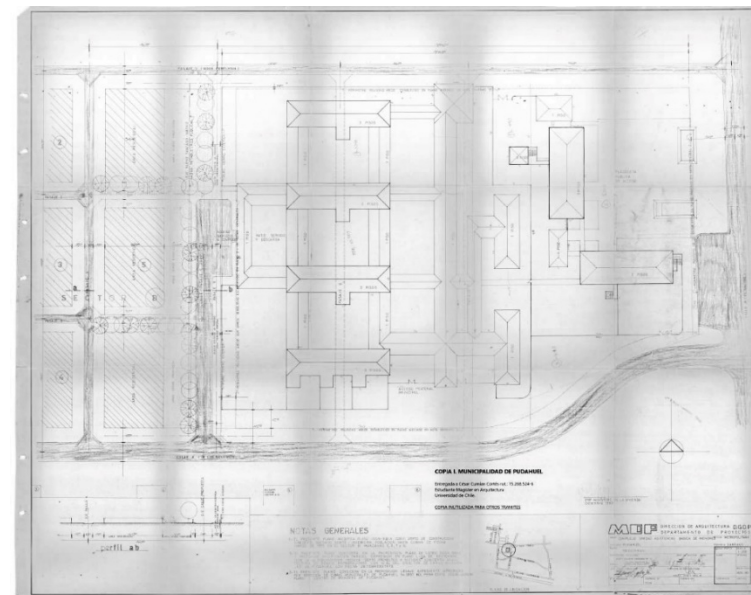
Planta Proyecto original. Archivo DOM Pudahuel.
